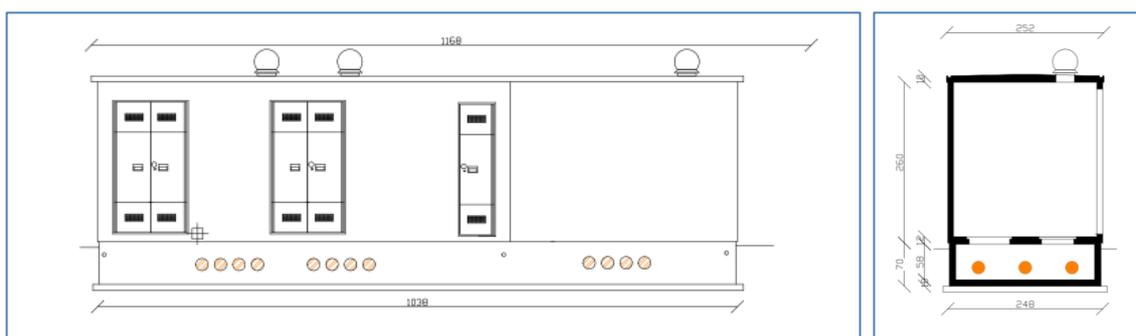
Prospetto lato strada e sezione tipo della cabina di consegna con posizionamento su vasca di fondazione
